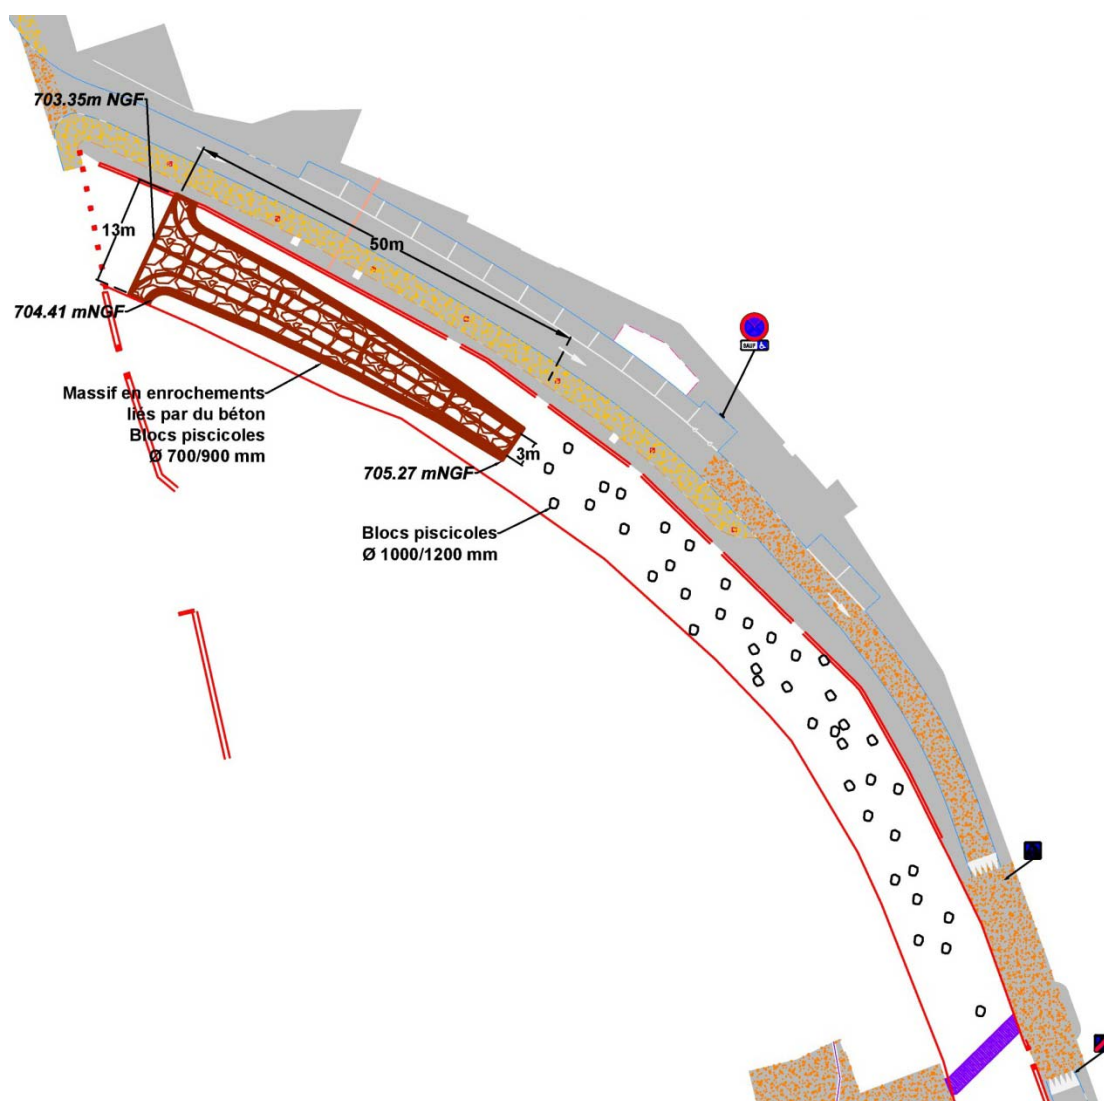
Aménagement du seuil Lissac - Vue en plan
